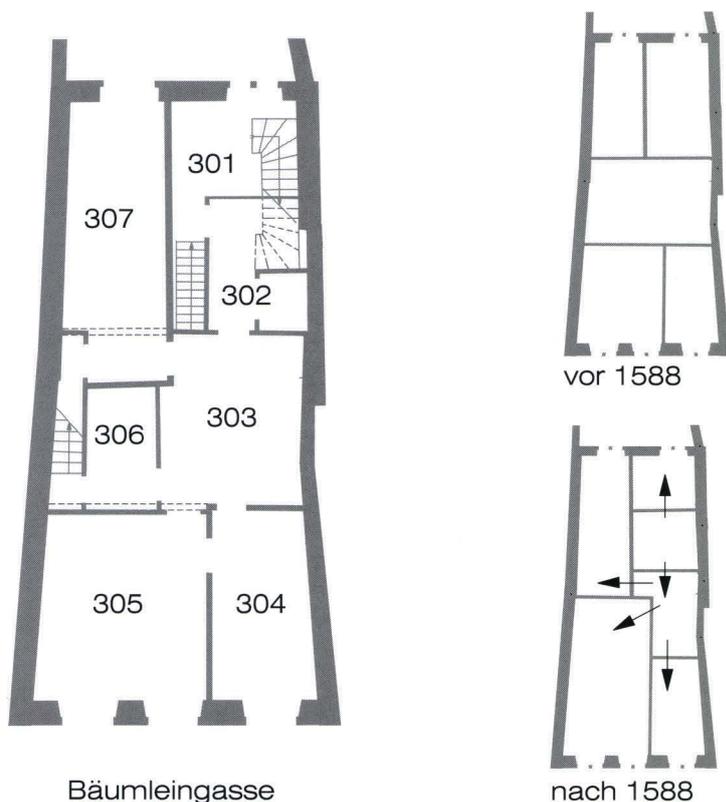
Bäumleingasse 4 (D 1998/05). Grundrissplan des 3. Obergeschosses mit Raum-Nummerierung. – Massstab 1:200. Rechts daneben zwei Rekonstruktionsversuche, welche eine mögliche Raumanordnung vor und nach der Erneuerung von 1588 illustrieren. – Überarbeitung: Hans Ritzmann.
